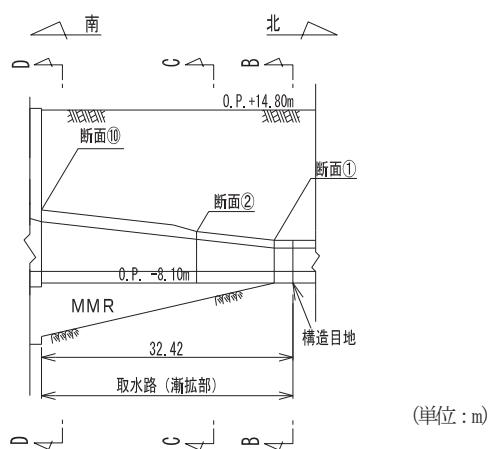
取水路（漸拡部）縦断図 (A-A) 及び候補断面位置
